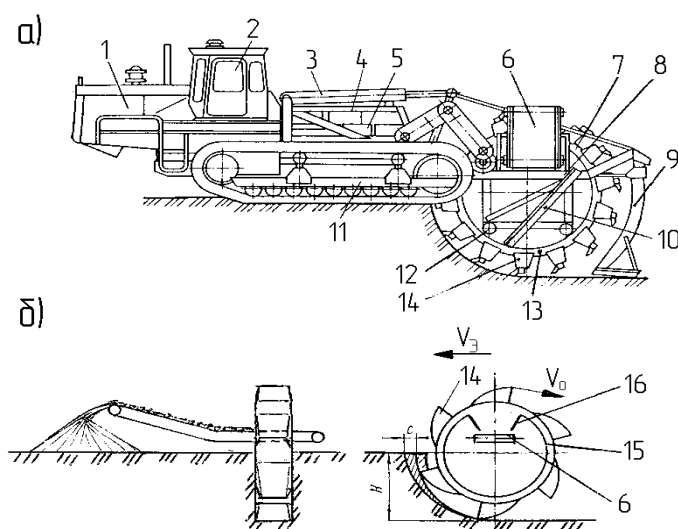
Экскаватор траншейный роторный: а) - общий вид; б) - схема работы: 1 - силовая установка; 2 - кабина машиниста; 3 - механизм подъема-опускания рабочего оборудования; 4 - дополнительная рама; 5 - трансмиссия экскаватора; 6 - отвальный конвейер; 7 - ротор; 8 - рама рабочего оборудования; 9 - зачистное устройство; 10 - ножевой откосник; 11 - гусеничный ход; 12 - опорные ролики; 13 - кольцо ротора; 14 - ковши; 15 - защитный кожух; 16 - лоток
